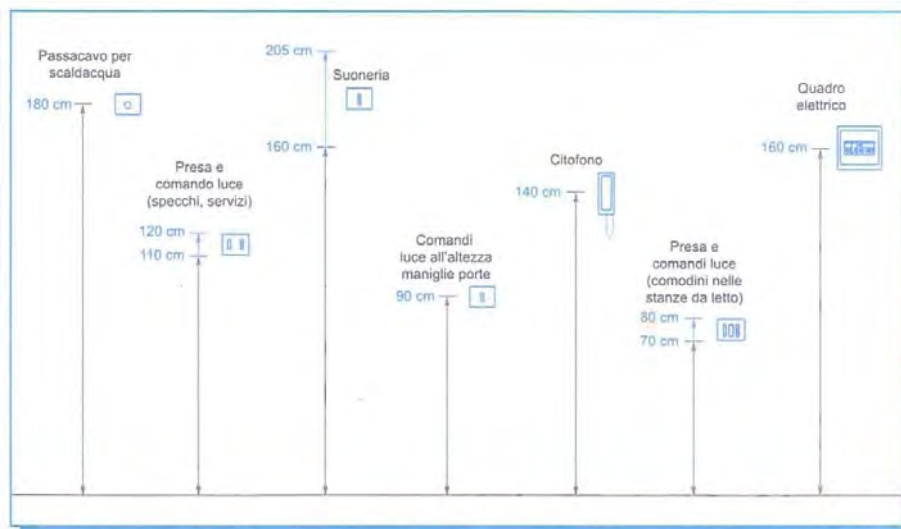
Quote di installazione delle apparecchiature negli edifici civili, secondo la guida CEI 64-50.
